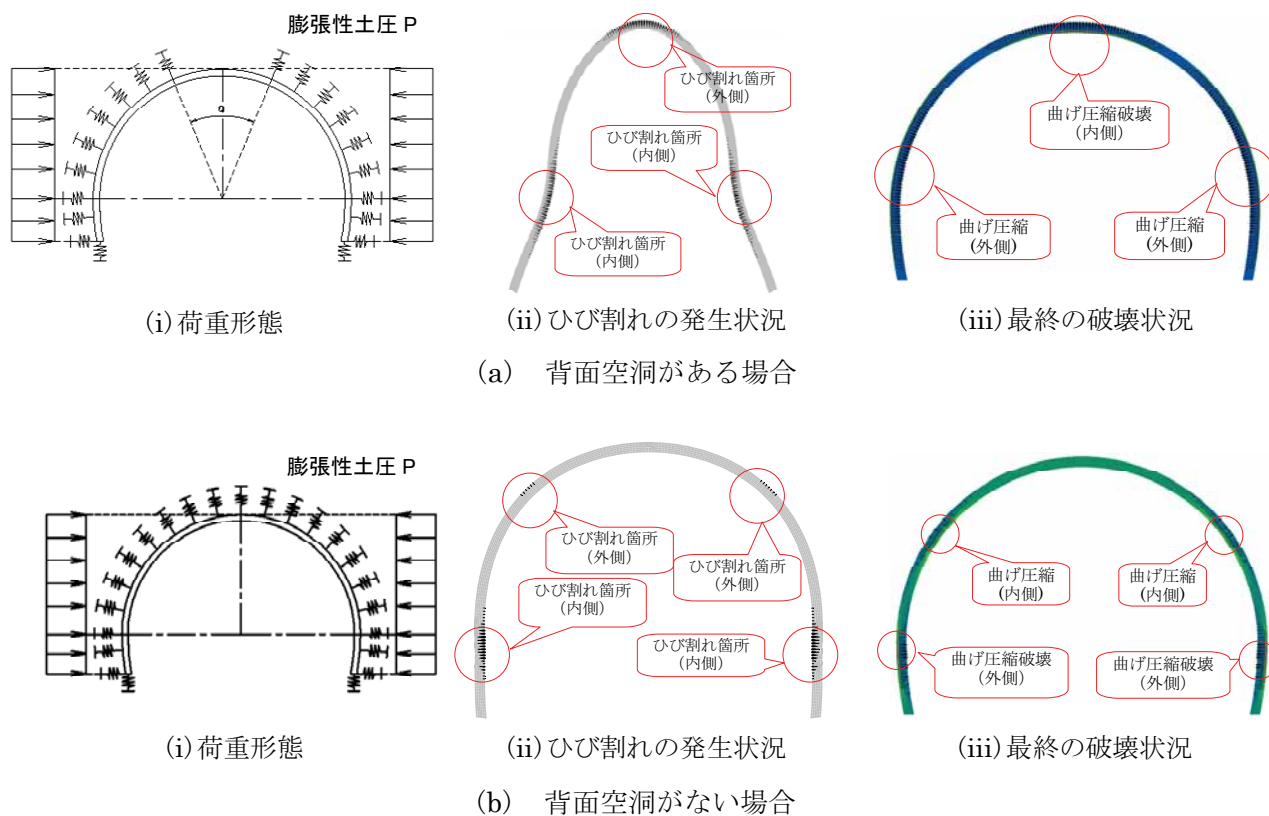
膨張性土圧が作用する場合のひび割れ図および変形図
